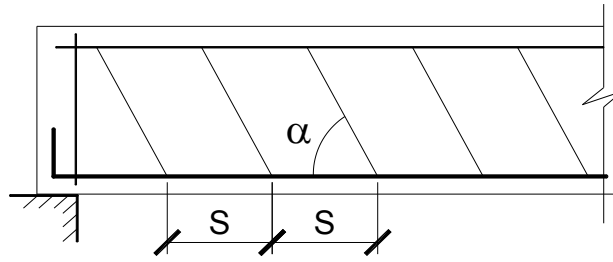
Елемент з похилою поперечною арматурою
